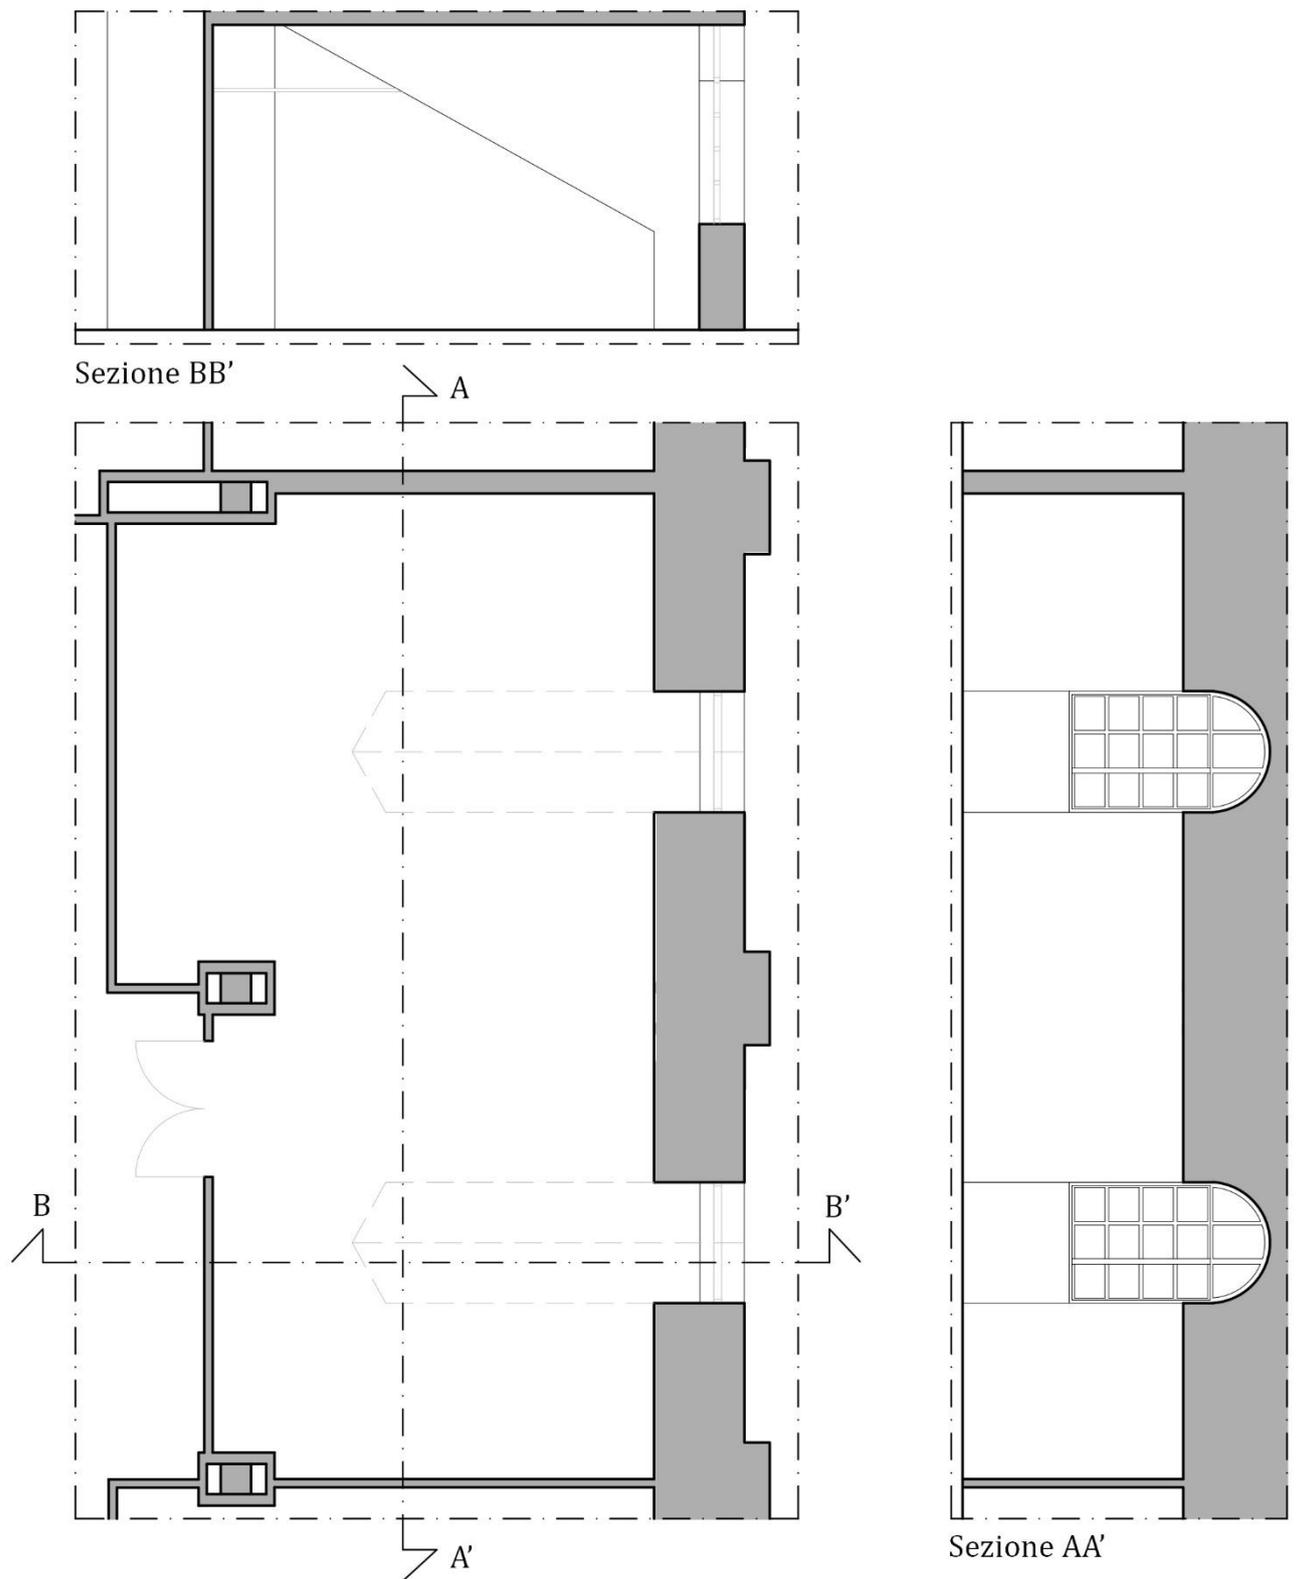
Pianta e sezioni in scala 1:100 della sala conferenze, situata a sud-ovest del secondo piano.
